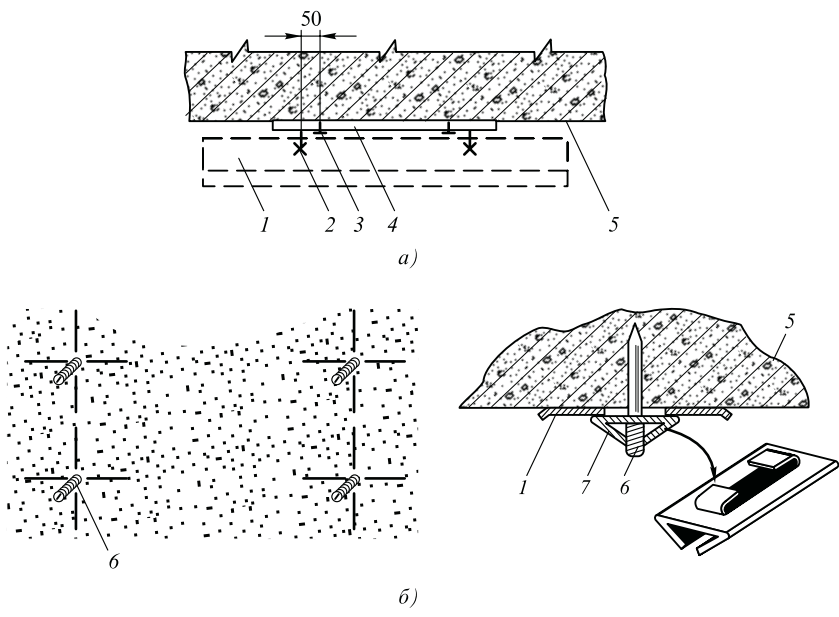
Установка светильника на конструкциях из полосовой стали (а) и дюбель-винтах (б):
